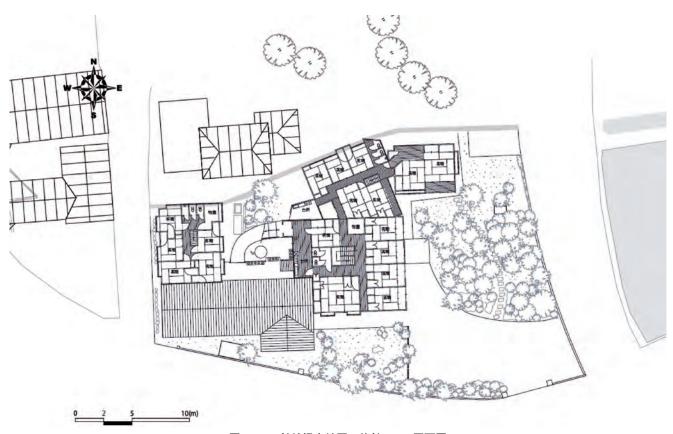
鉄輪温泉地区 旅館 F2F 平面図
